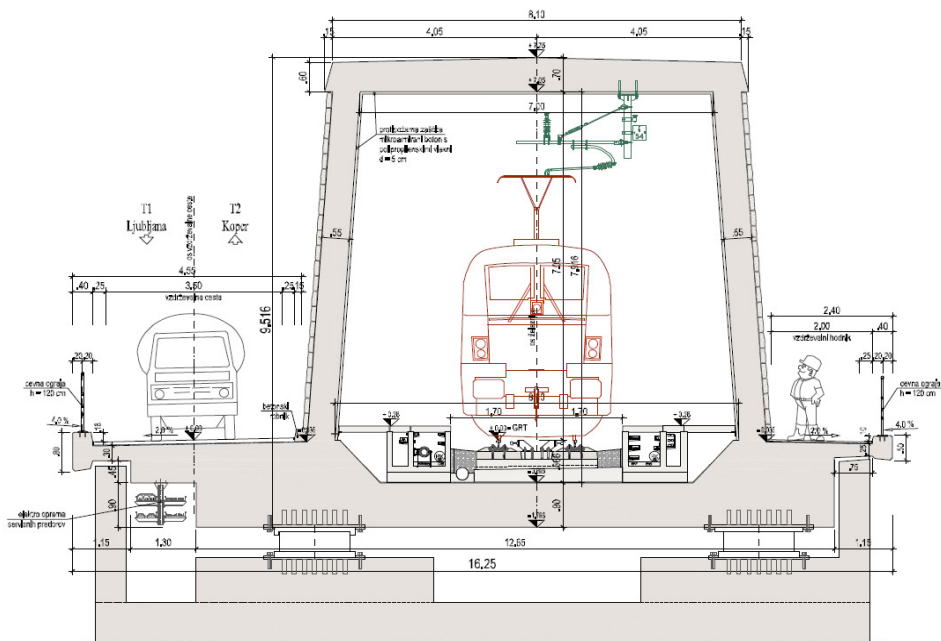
Tipico profilo trasversale della struttura di attraversamento oltre la valle del Glinščica
